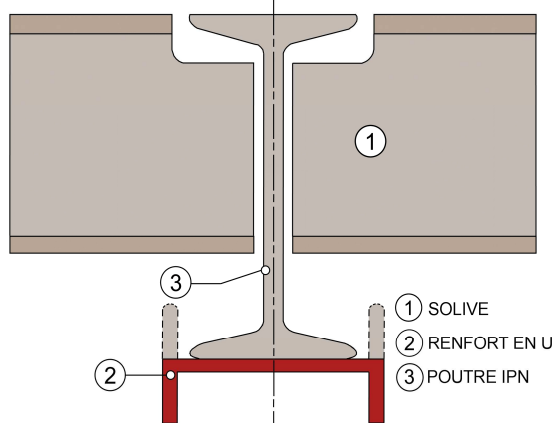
Ajout d'un profilé sous la semelle inférieure.
